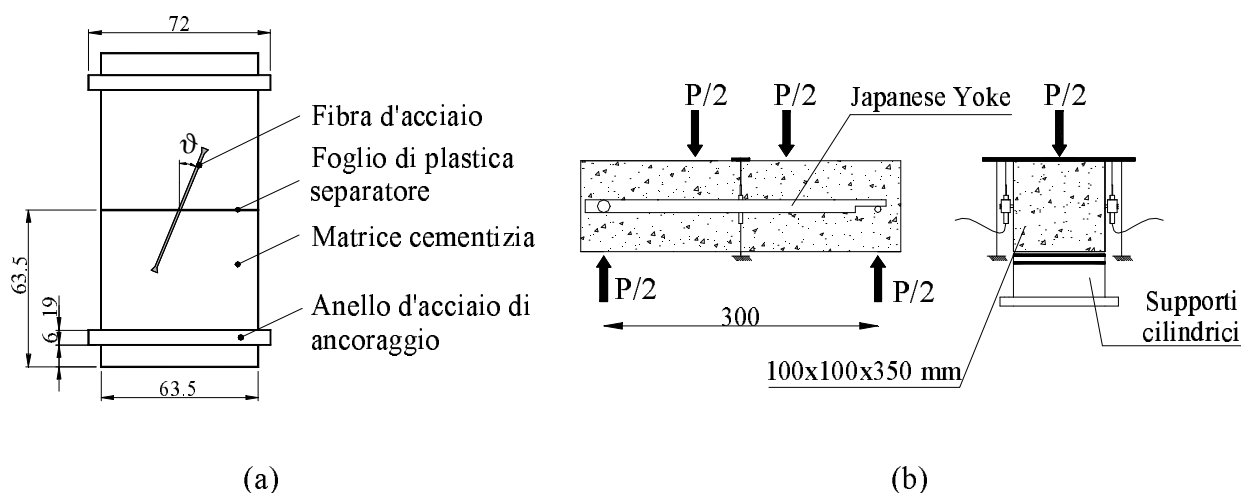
Provini per le prove di estrazione (a); sistema di fissaggio degli LVDT utilizzato nelle prove di flessione (b) (misure in mm).
